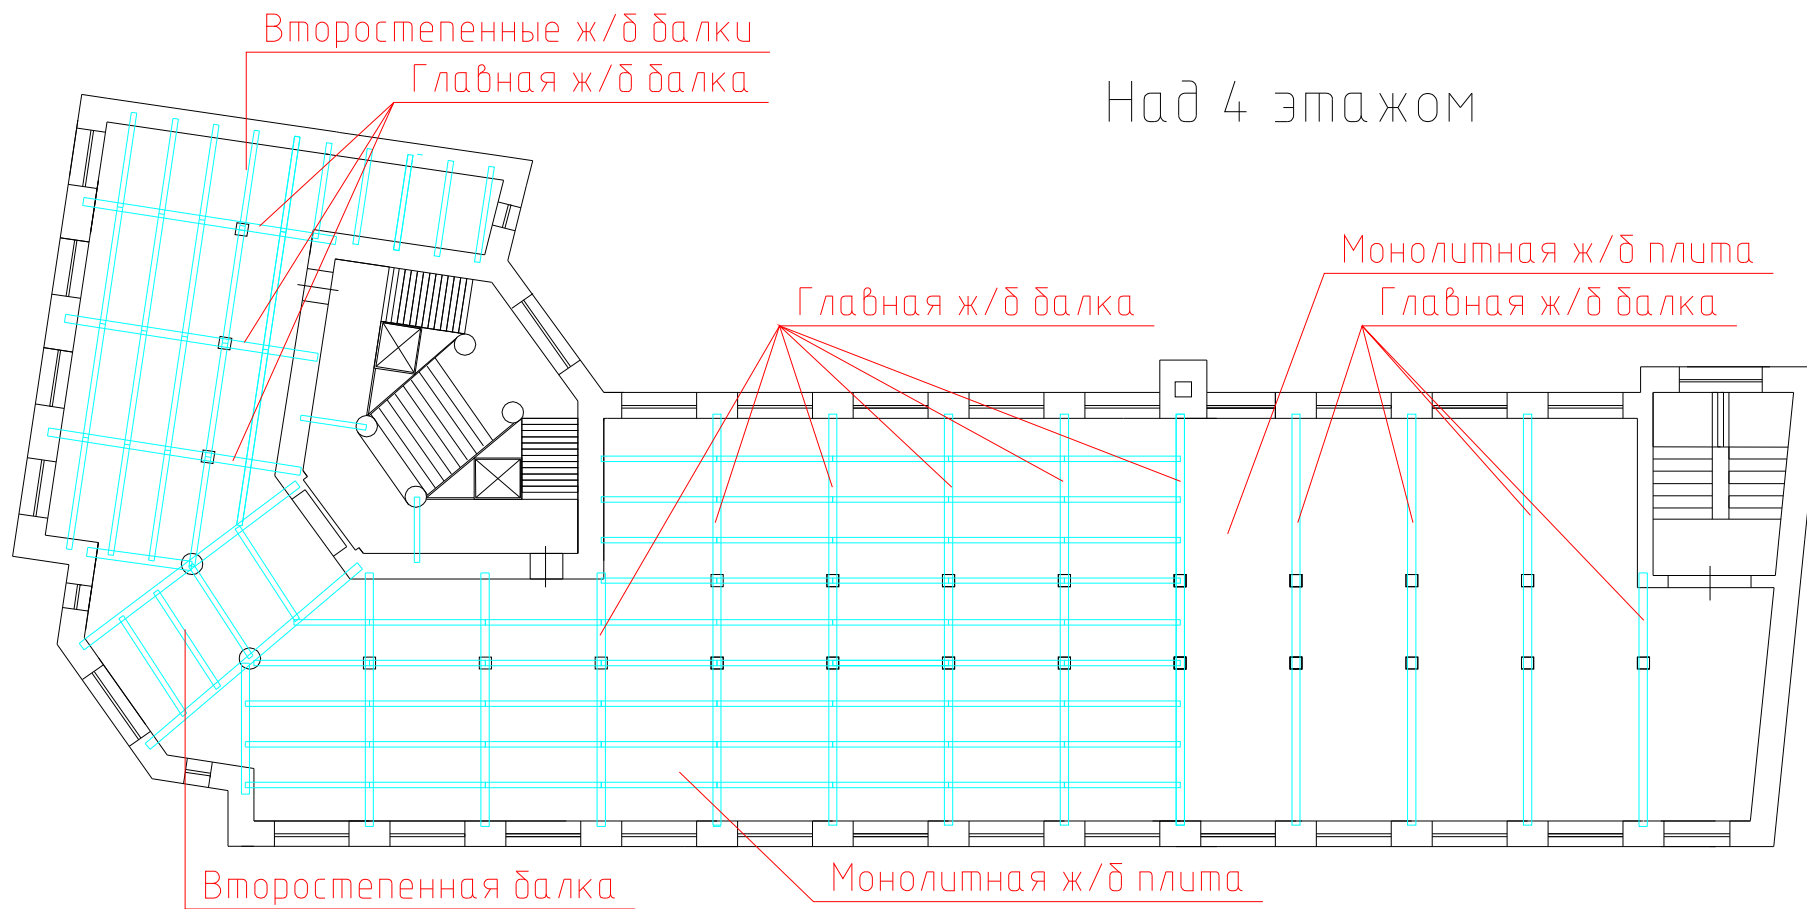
Схема главных и второстепенных балок монолитного ж/б перекрытия над четвертым этажом
